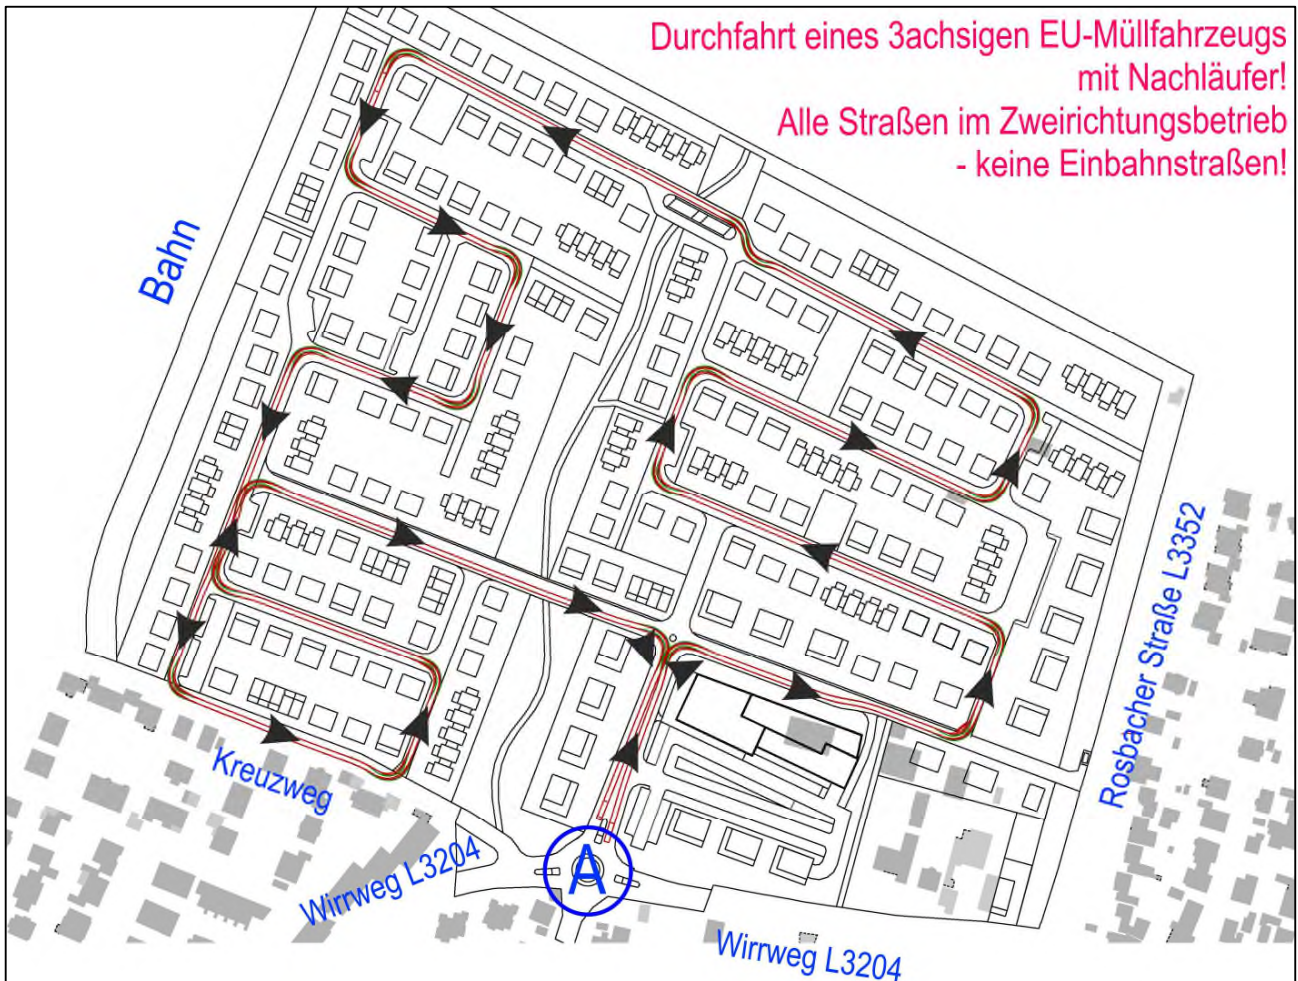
Fahrkurven der Räder eines 3achsigen EU-Müllfahrzeugs mit Nachläufer, das in Pfeilrichtung das Plangebiet „Am Belgesbaum“ durchfährt. Alle Straßen im Zweirichtungsbetrieb – keine Einbahnstraßen!
